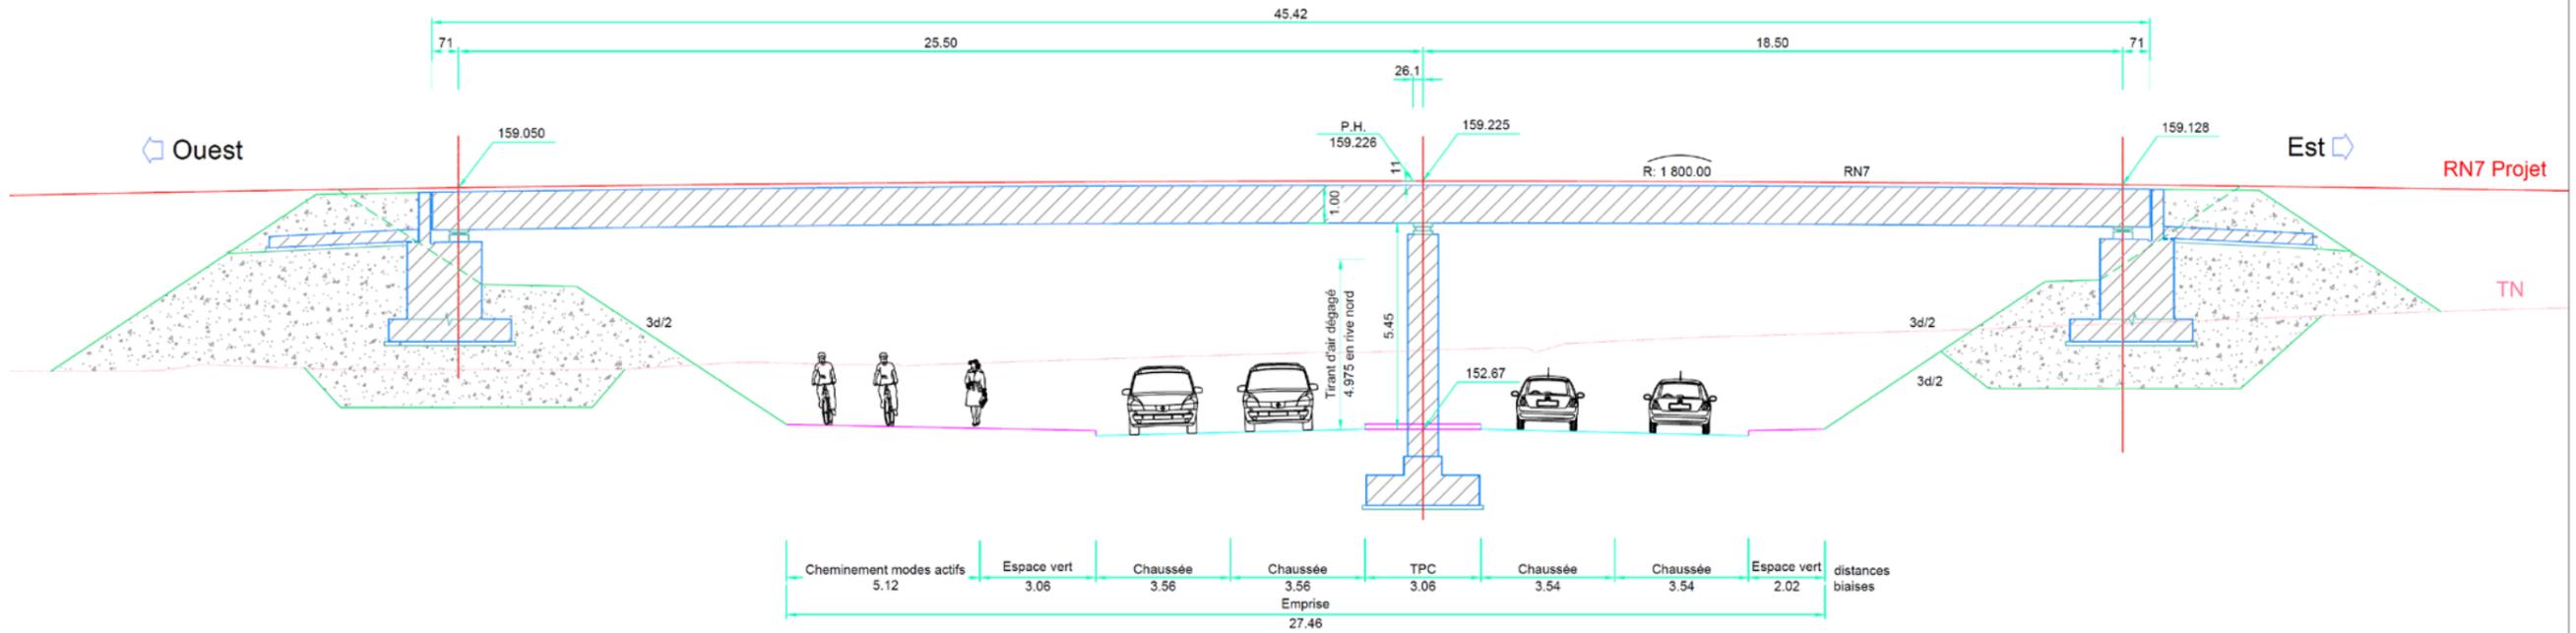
Coupe longitudinale de l'ouvrage d'art OA2
